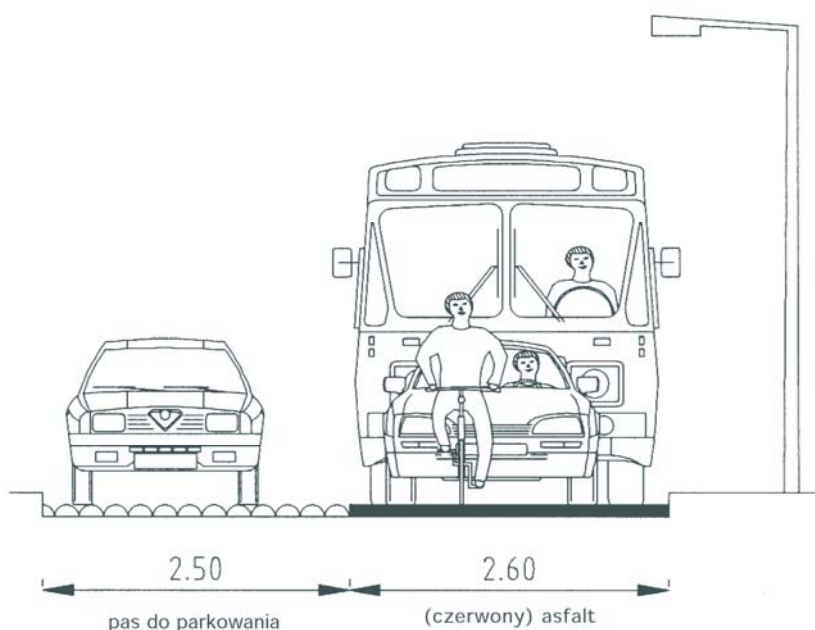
Pas ruchu dla rowerów przy parkingu – miejsca postojowe ukośne
